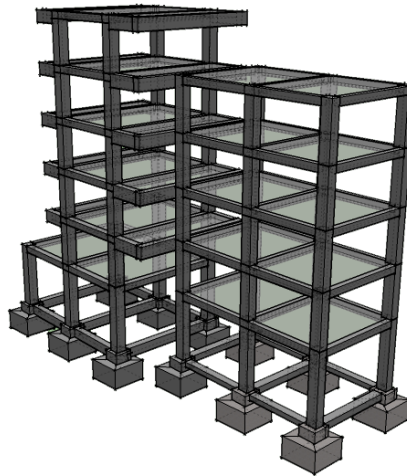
PROPUESTA CONCEPTUAL PARA ESTRUCTURA: MARCOS DE CONCRETO REFORZADO.
